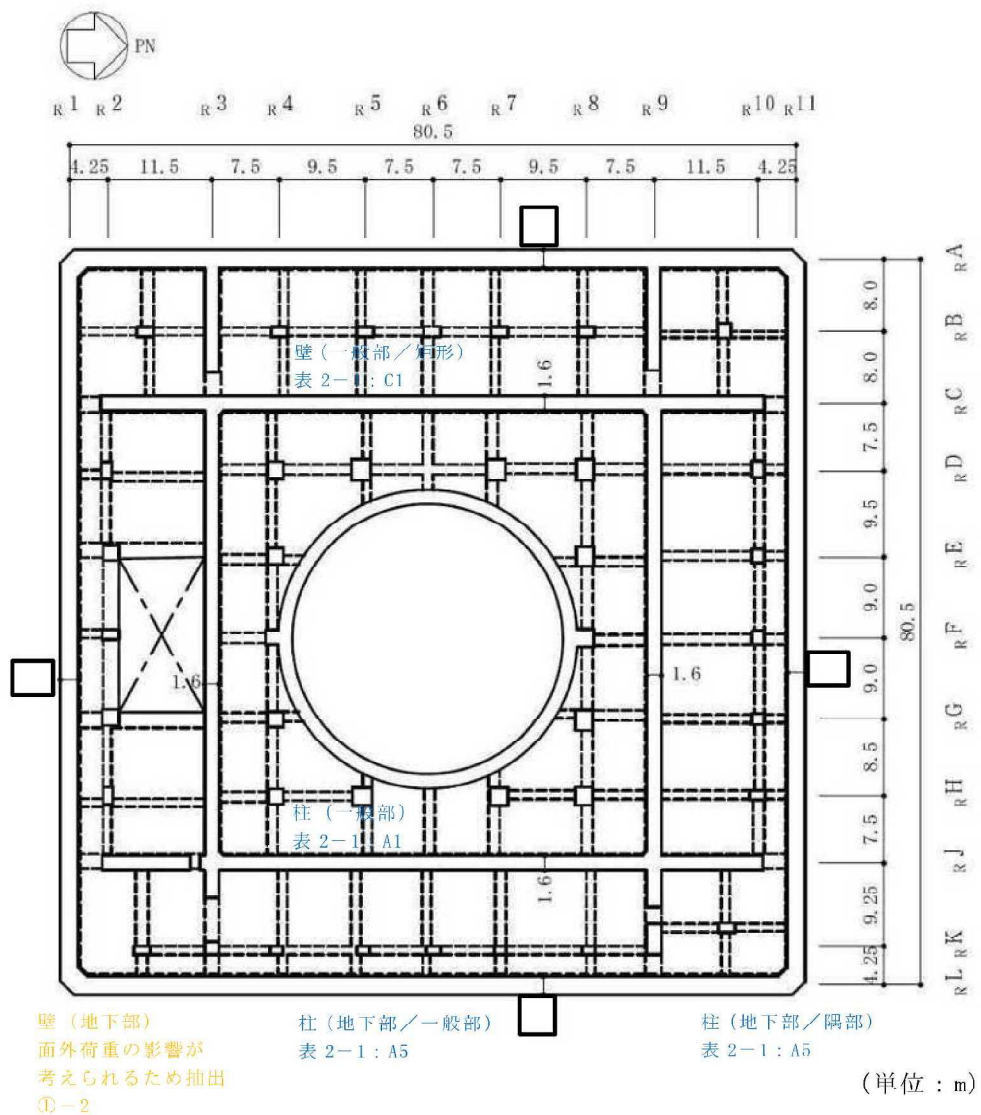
5号機原子炉建屋の概略平面図 (B2F, T.M.S.L. -1.1m) (3/9)
